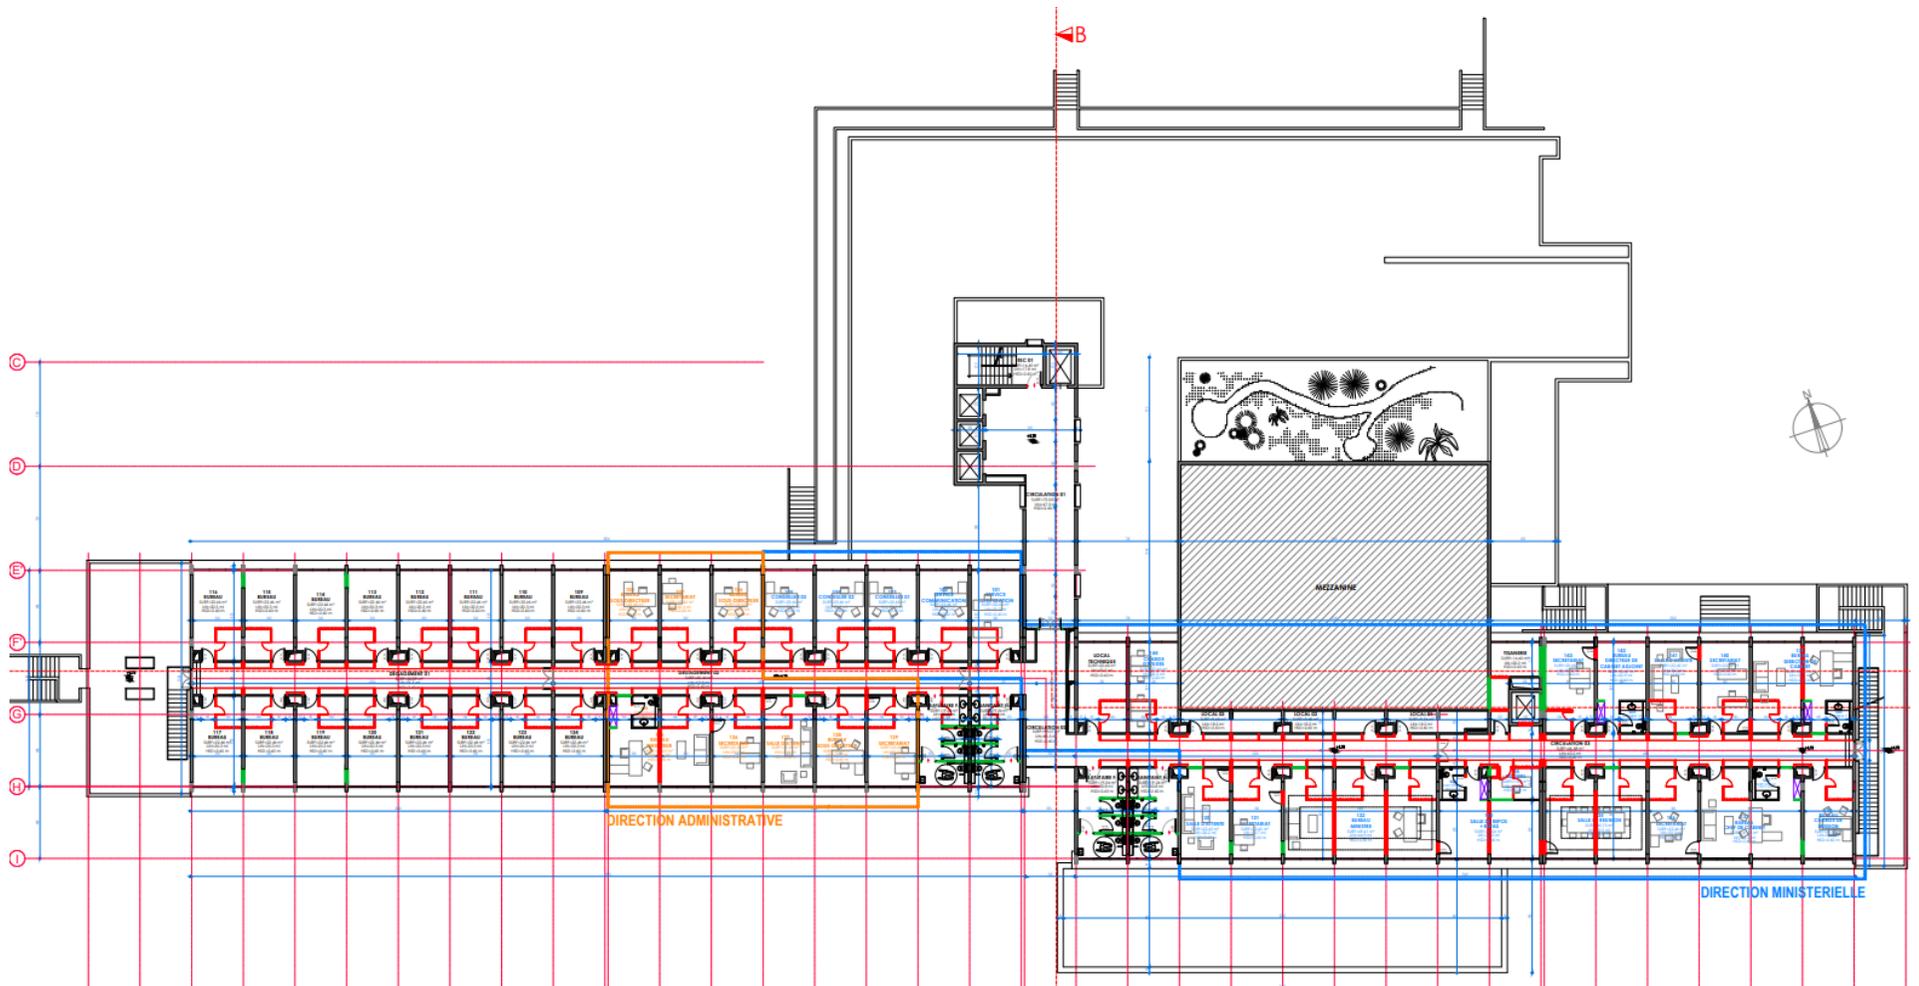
Plan de masse ex-Hôtel SEBROKO
